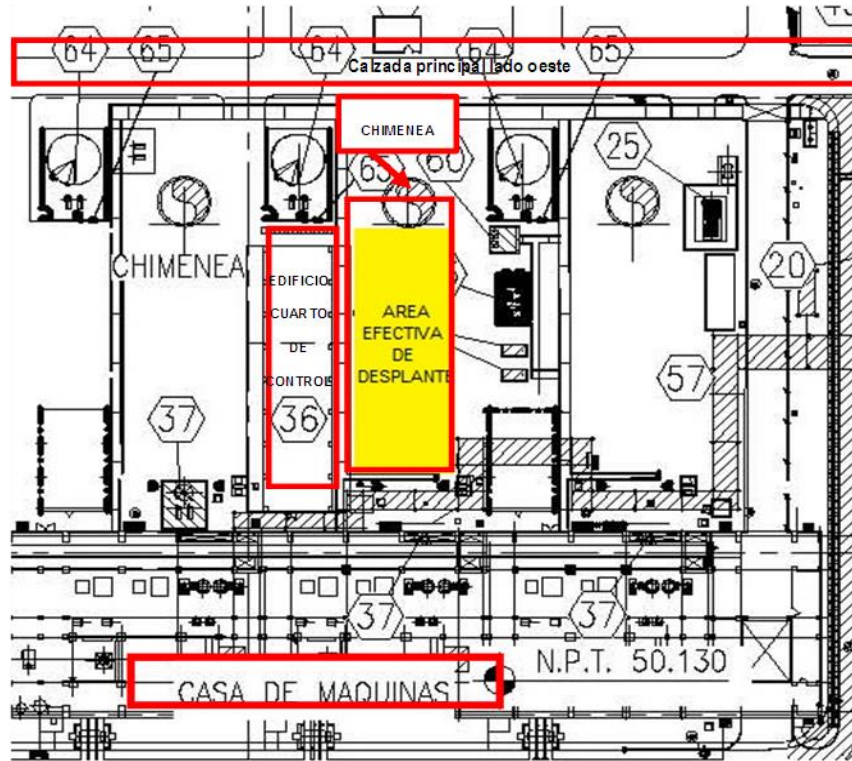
Ubicación del desplante para la instalación de la planta piloto.
